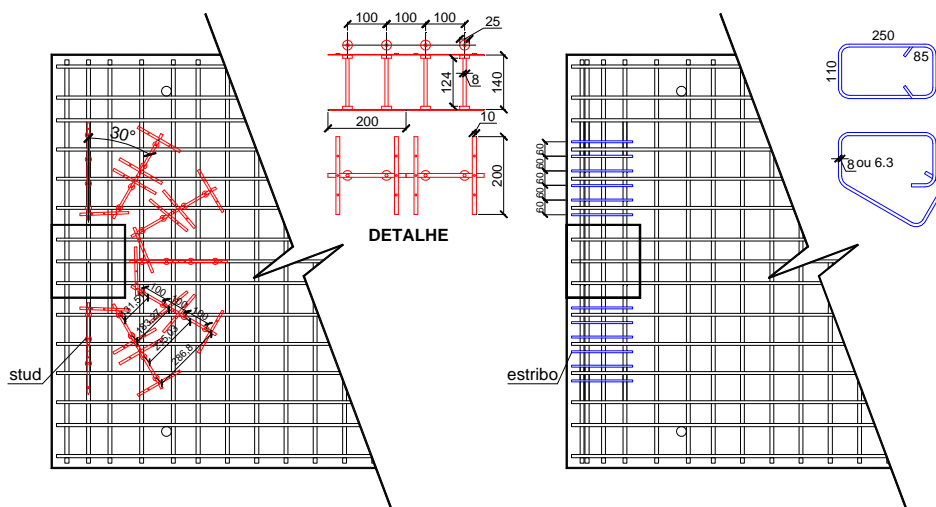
Detalhe das armaduras de cisalhamento e torção
